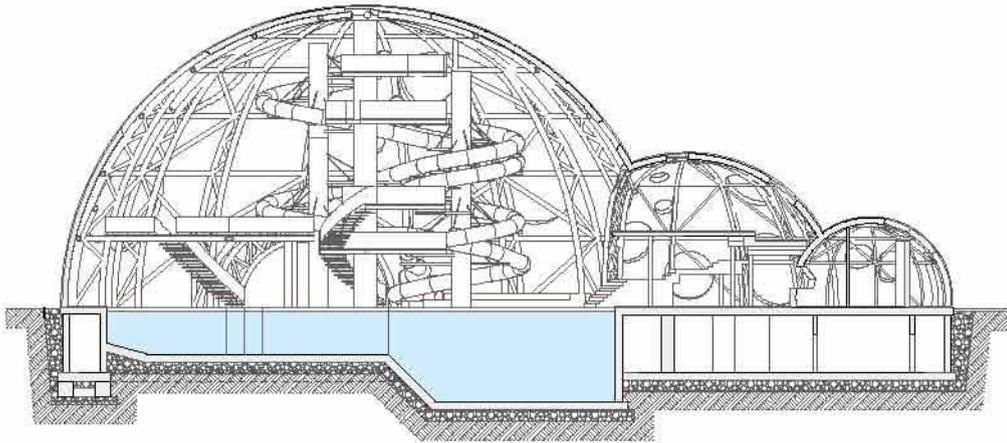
Schnitt ff Hallenbad Großes Becken und Bistro
